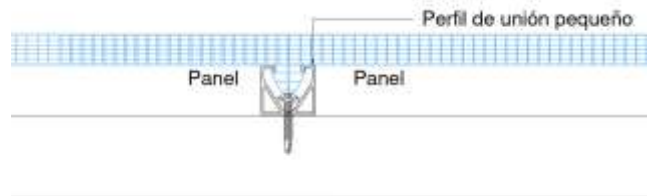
Detalle del encastre entre paneles con perfil de unión.
